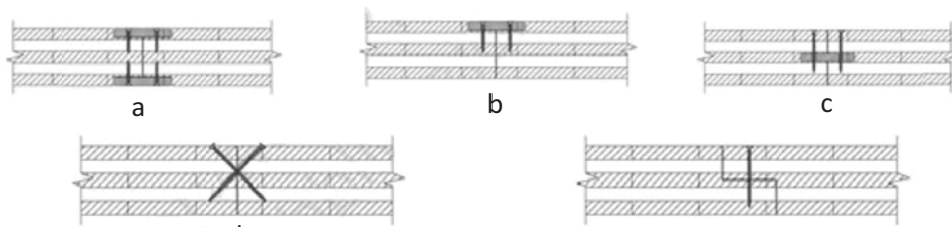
Sistema^d meccanico di collegamento parete – parete di pannelli X-LAM.²¹
